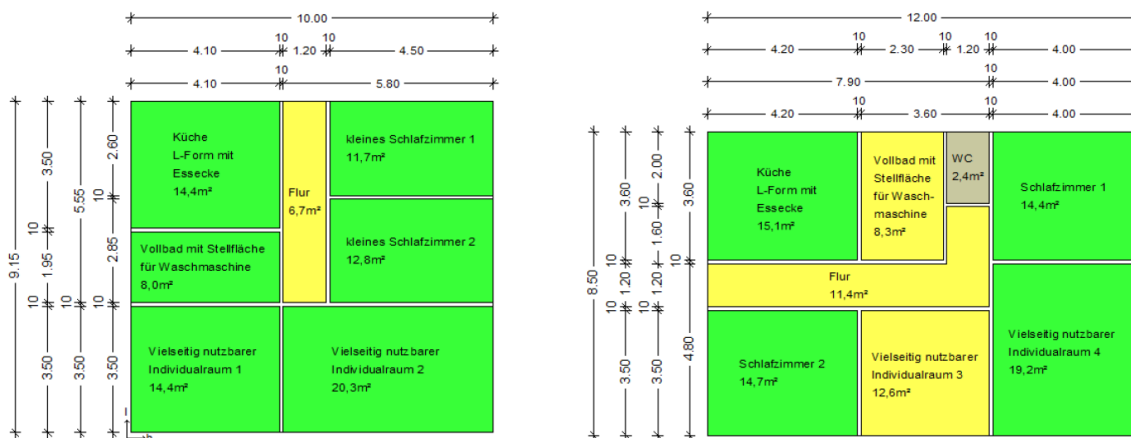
Grundriss 3 (links) und Grundriss 4 (rechts)
